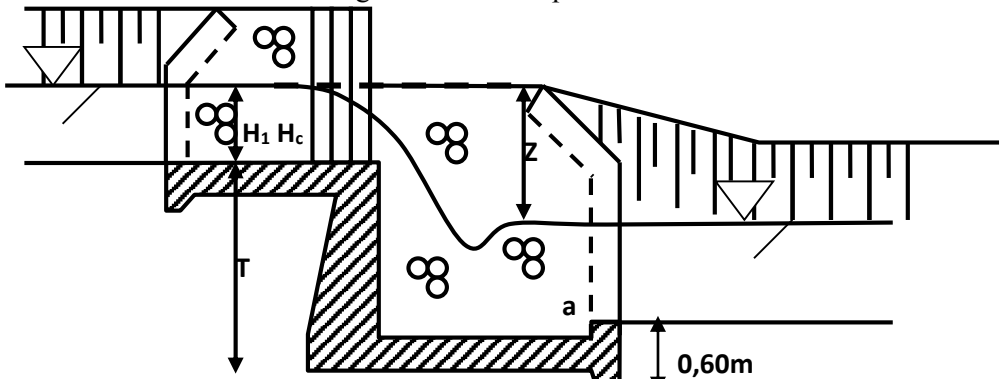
14 denah dan penentuan ketinggian bangunan terjunan
